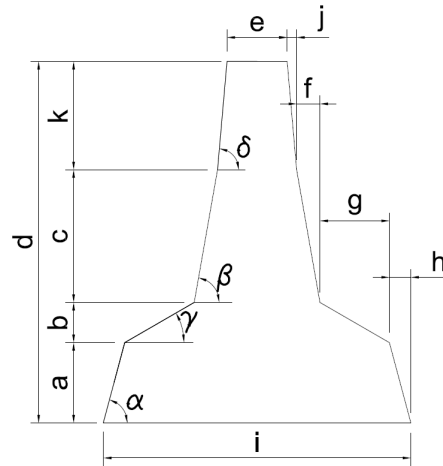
Parámetros del perfil de barrera con 4 planos.
